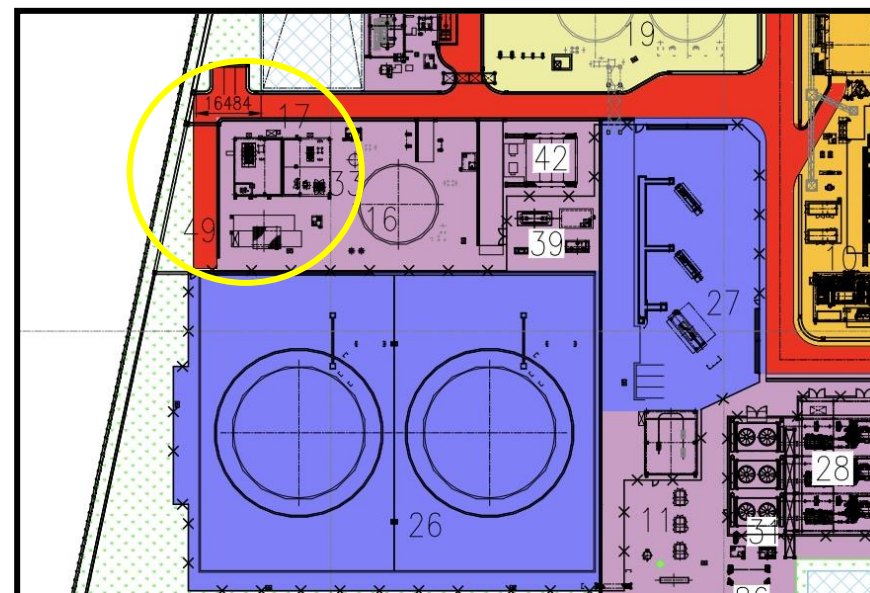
ตำแหน่ง Portable Water System ในผังการใช้ประโยชน์โครงการ
